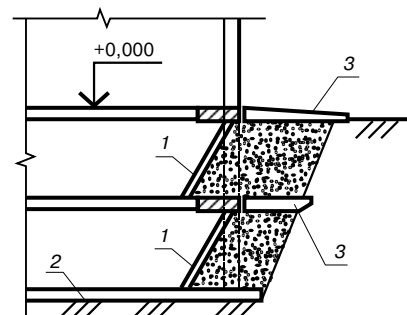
Сейсмостойкое здание с двухэтажным подвалом: 1 – наклонная стена подвала; 2 – монолитная плита; 3 – плиты-экраны (авторское свидетельство СССР № 1673722)
